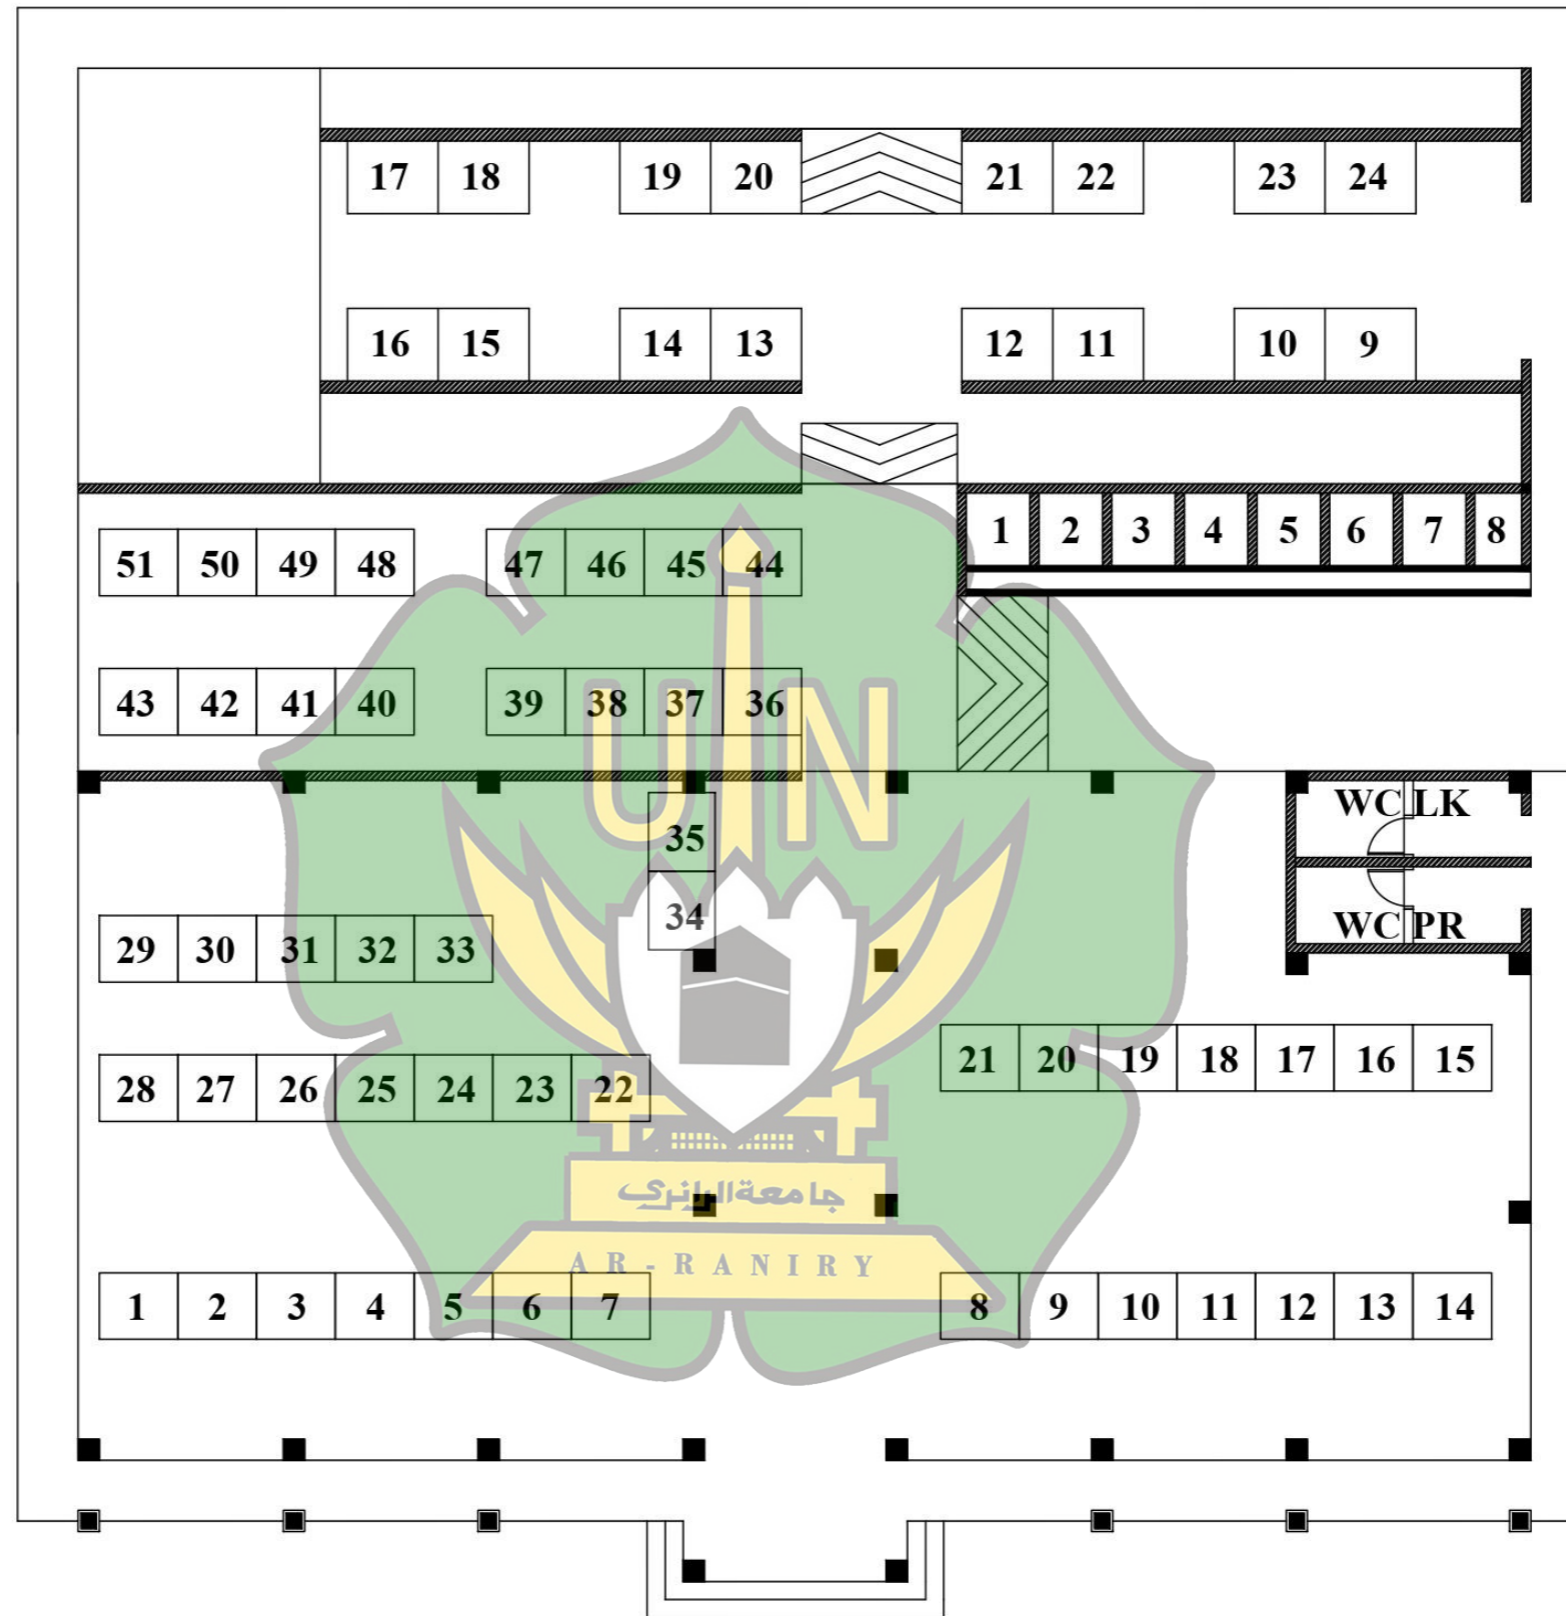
Denah Gedung A (Pasar sayur rakyat)
